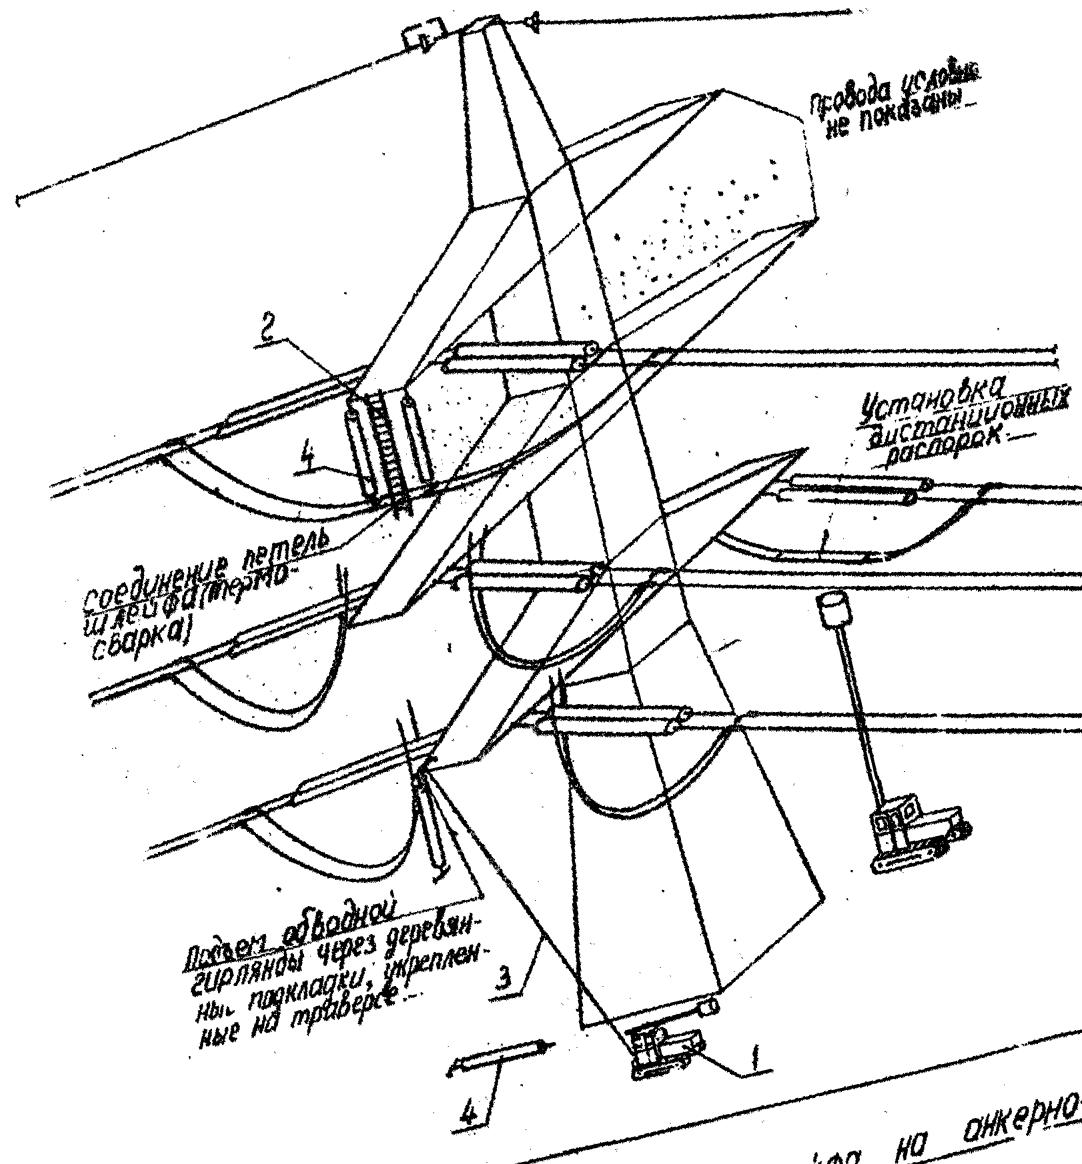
Монтаж петель шлейфа на анкерно-угловой опоре
